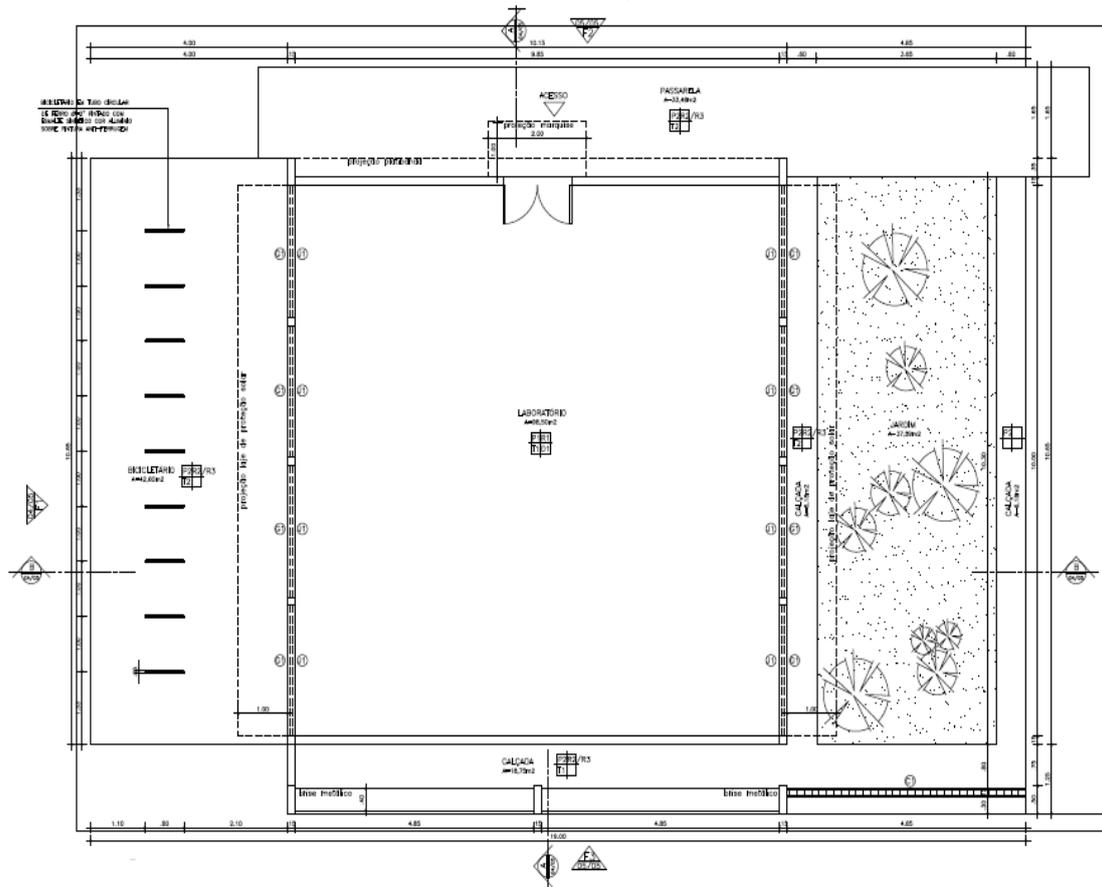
Planta de cobertura do projeto final do estudo de caso. (Fonte: COP/UFC)
